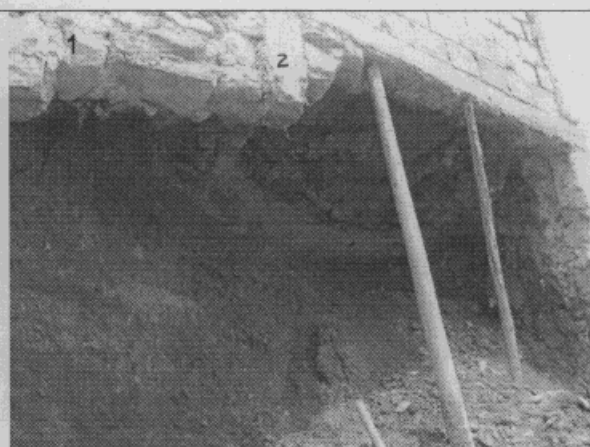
Detalle del suelo de fundación de la vivienda del Señor Méndez, parte del muro en piedra pegada que lo contenía (1) y la columna intermedia de confinamiento del muro (2).
